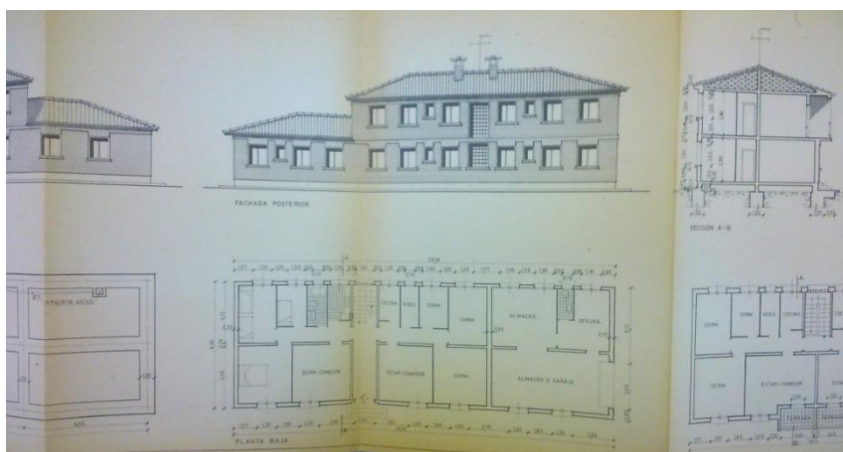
Planta y alzado. [Fuente: Archivo Municipal de Cartagena]
